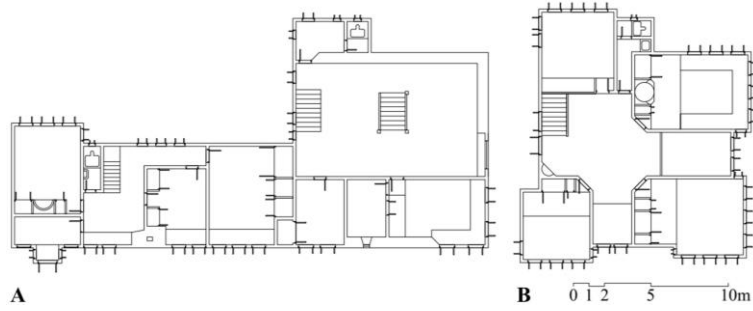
Hindistan Büyükelçilik Konutu, kat planları. A) Alt kat planı B) Üst kat planı
